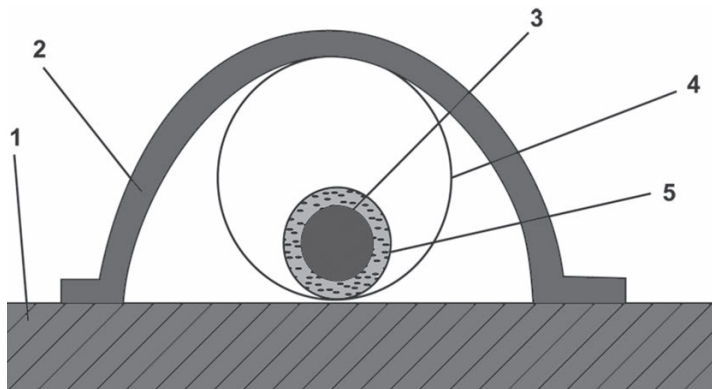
Крепление электропроводки в трубе: 1 — стена; 2 — металлическая скоба; 3 — провод; 4 — труба; 5 — асбестовый шнур
